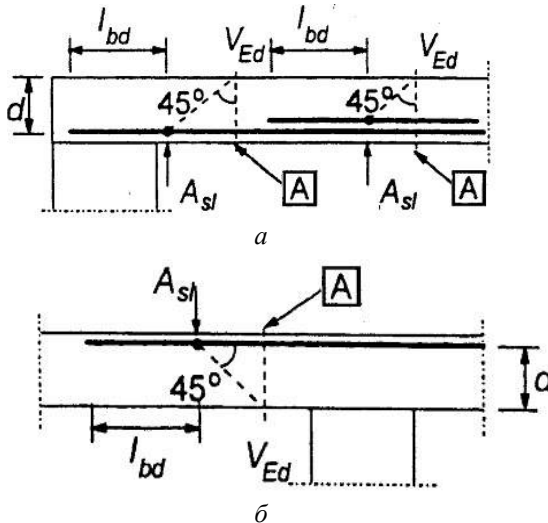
До розрахунку похилих перерізів: *a* – за умови вільного опирання; *б* – для проміжних опор нерозрізних балок
